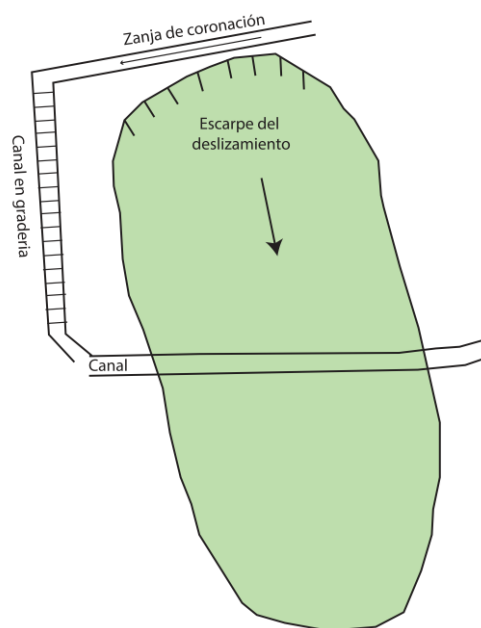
Esquema en planta del canal colector para el deslizamiento.
